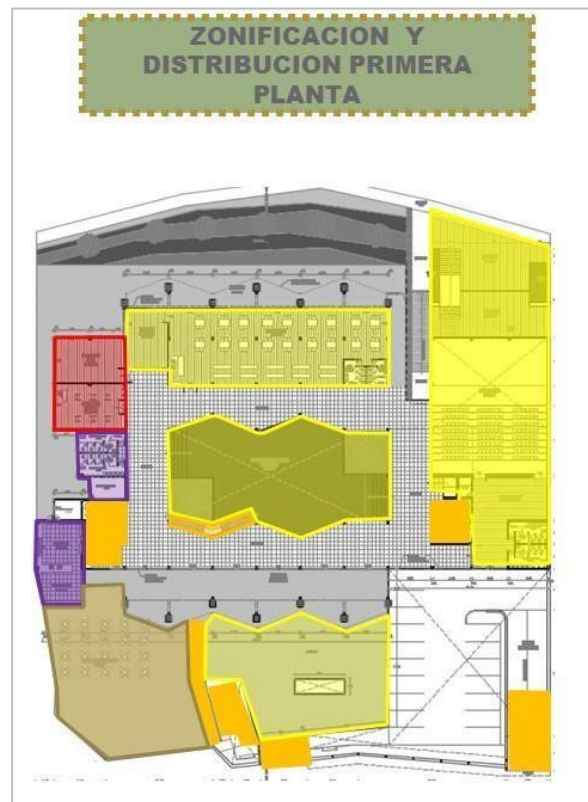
distribución primera planta de la propuesta arquitectónica.
